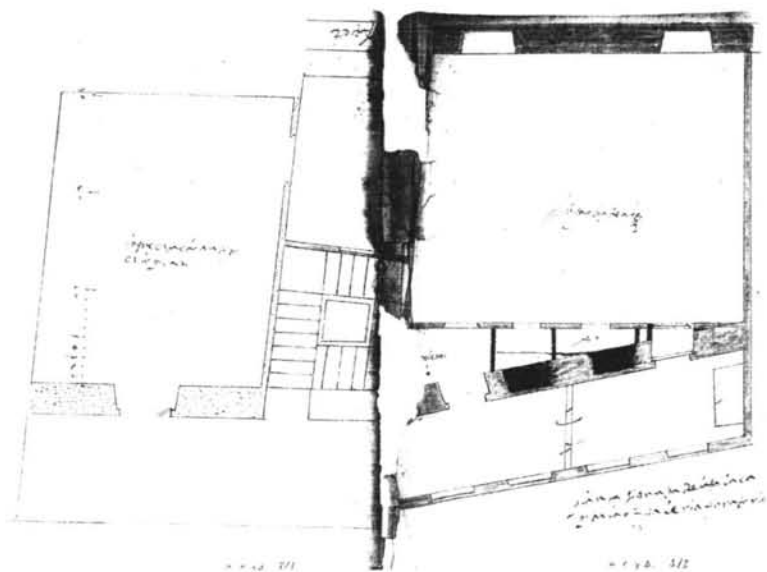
Juan García de Aro. 1655. A la izquierda, planta principal del Ayuntamiento de Toro. A la derecha, planta principal de las casas accesorias.
